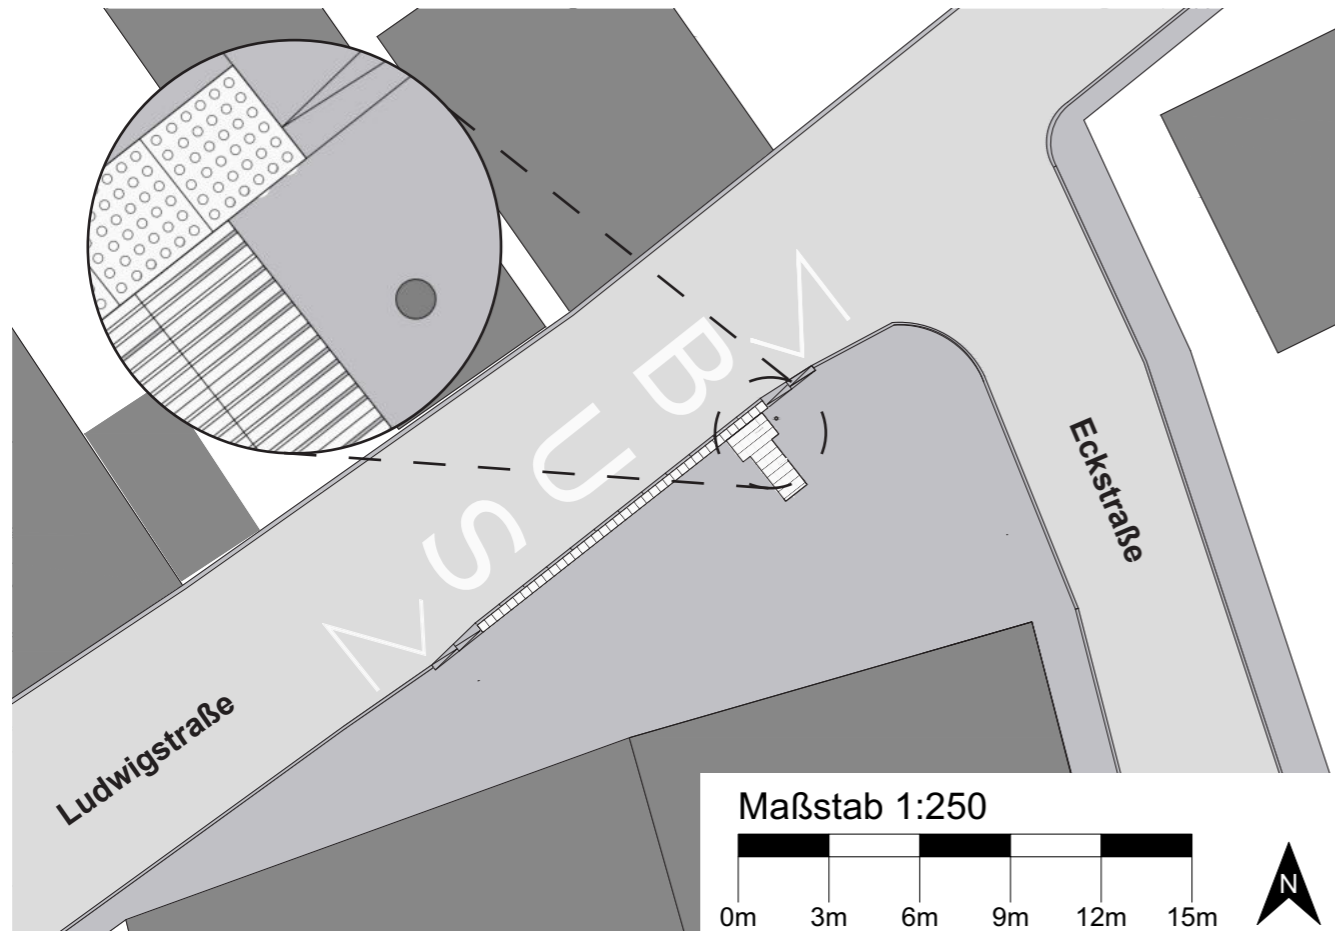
Detailzeichnung Bushaltestelle Ludwigstraße Ecke Eckstraße
